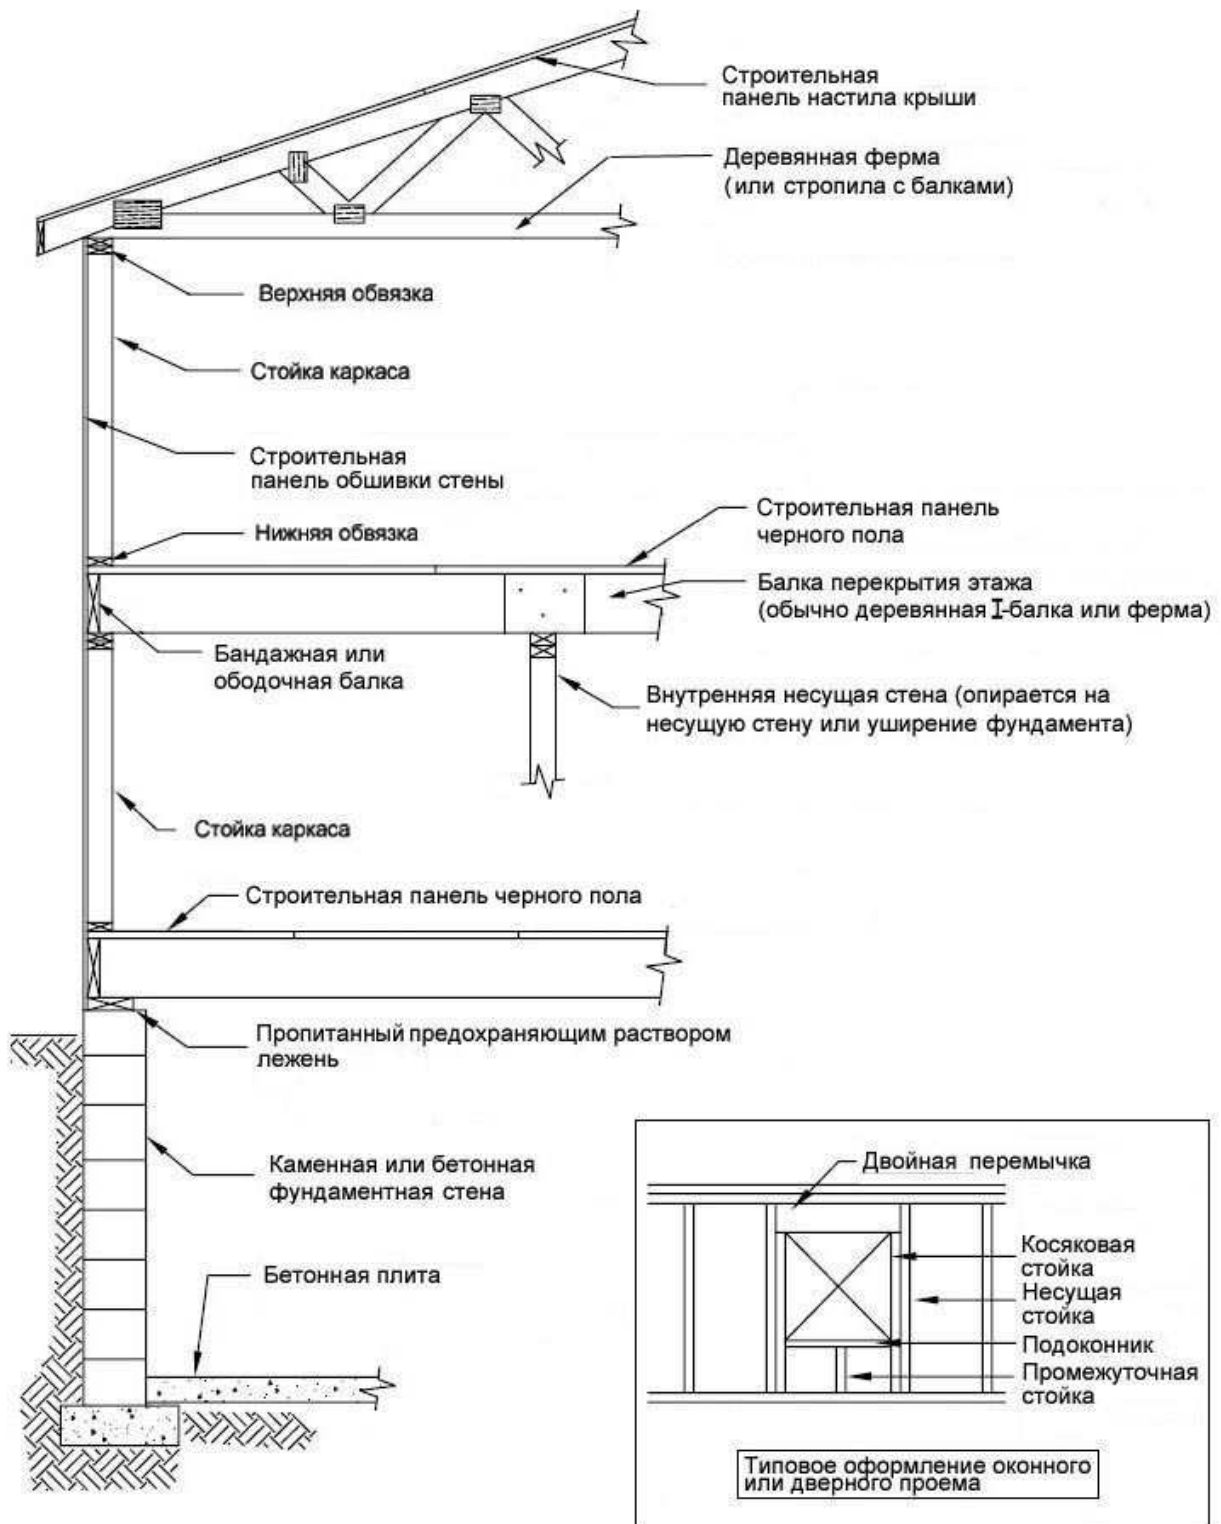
Поперечное конструктивное сечение деревянного дома каркасной конструкции
